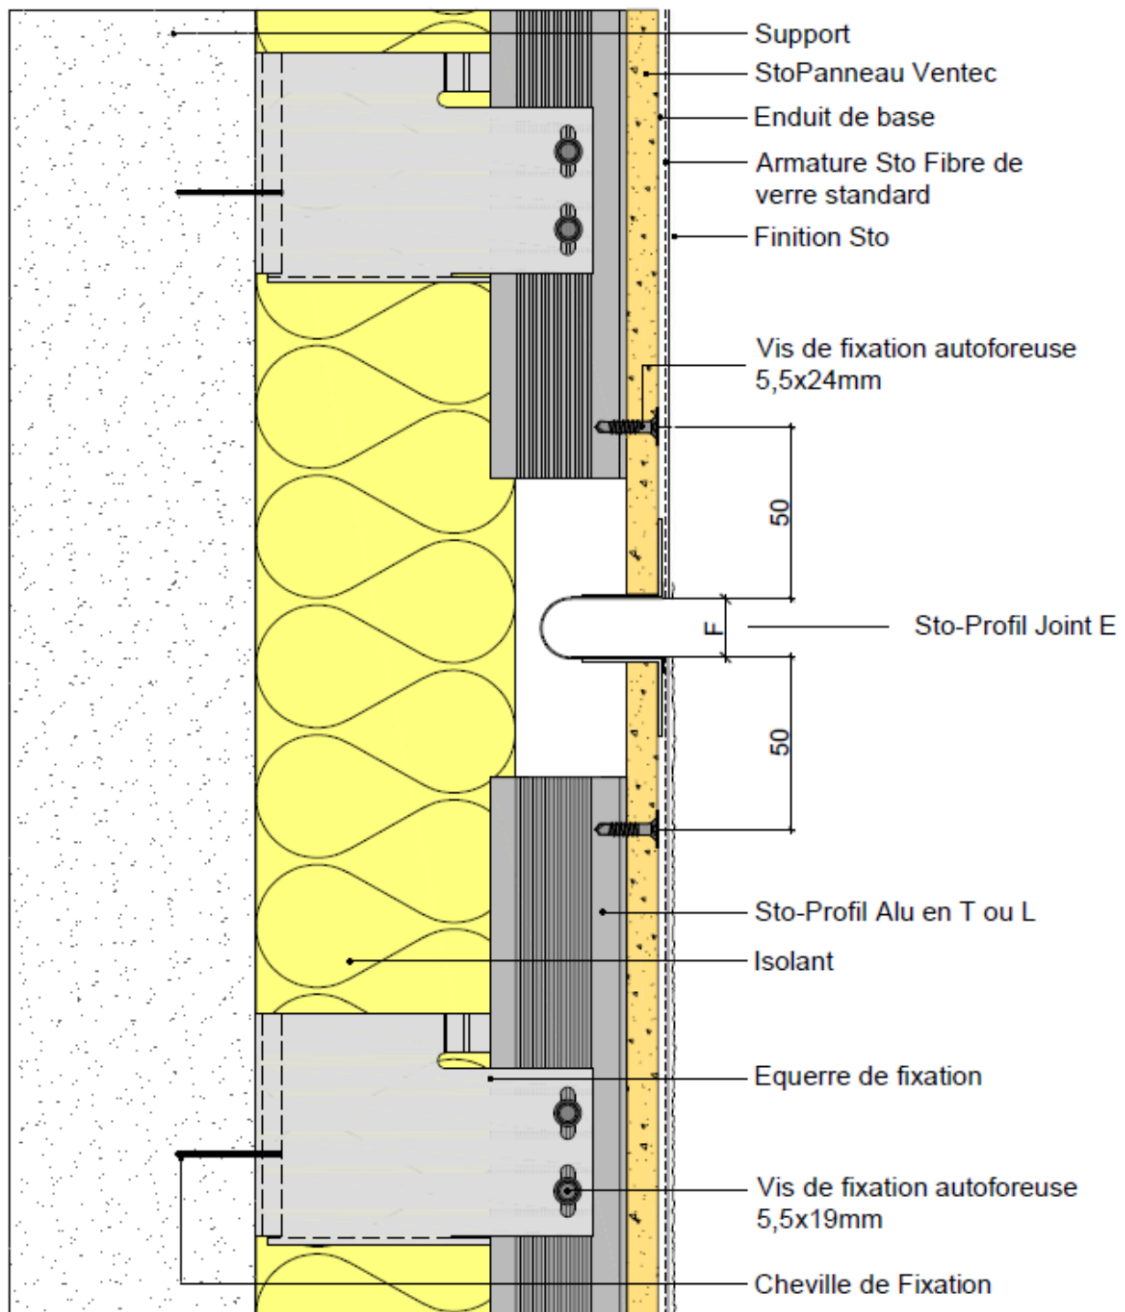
Coupe verticale - Fractionnement à joint fermé - Ossature aluminium
